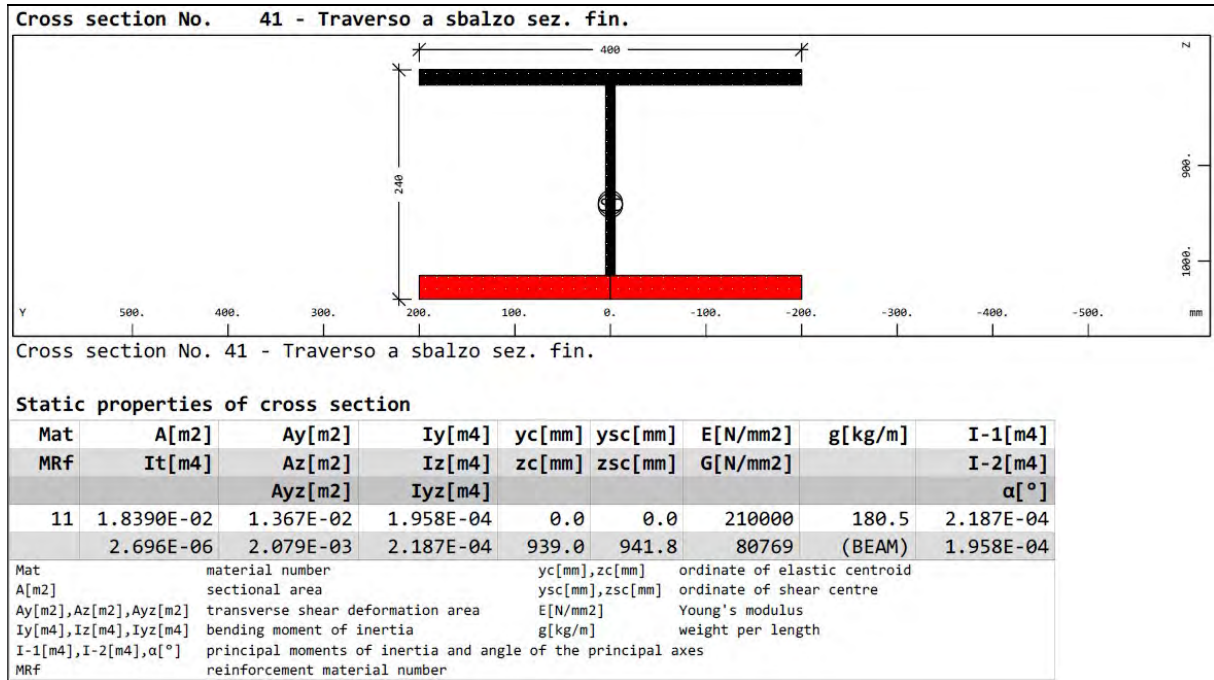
Trave a sbalzo – “Sezione di estremo libero”
